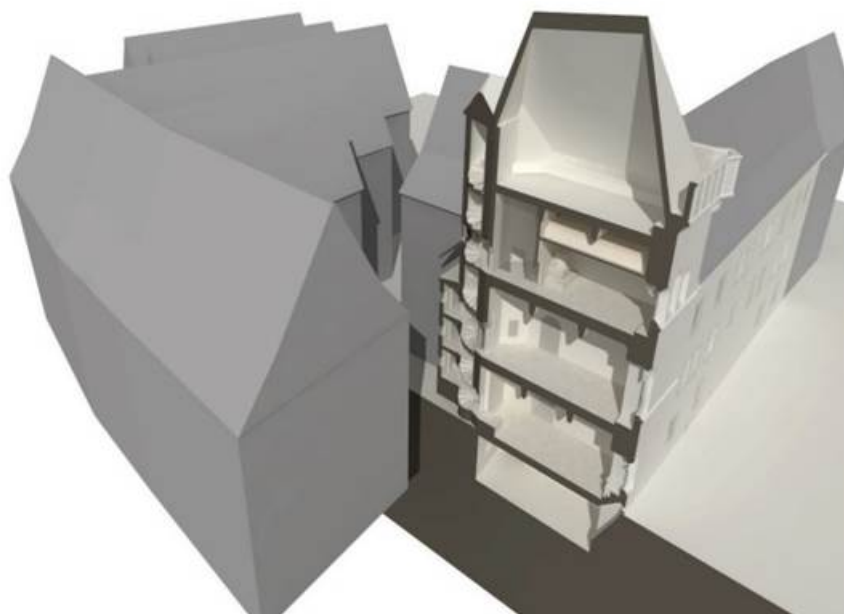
Дома «У звону» в Праге: разрез башни, винтовой лестницы и караульных помещений (<https://www.ghmp.cz/en/buildings/stone-bell-house/>)
